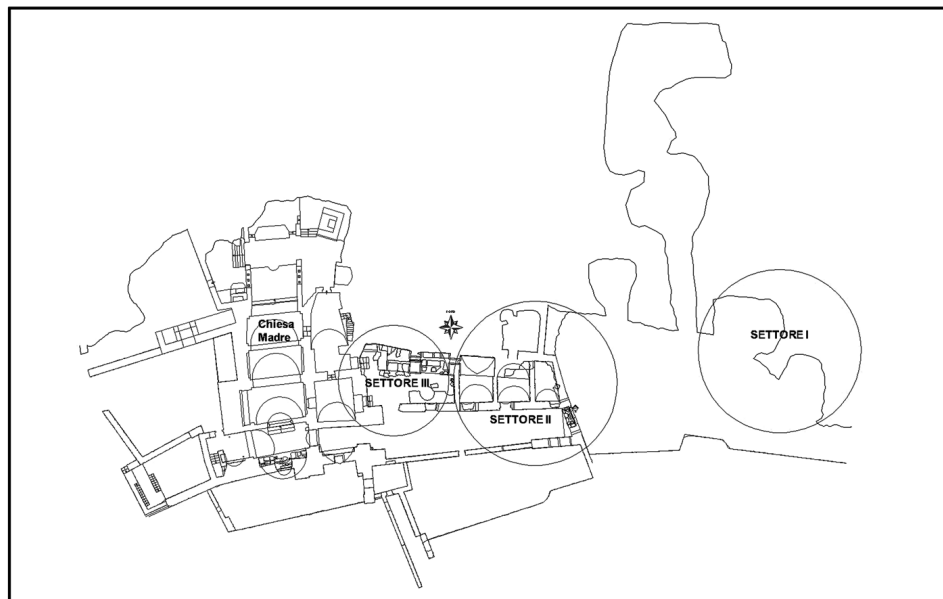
Planimetria generale dei settori di intervento (Archivio SAR Puglia, elaborazione degli autori).
